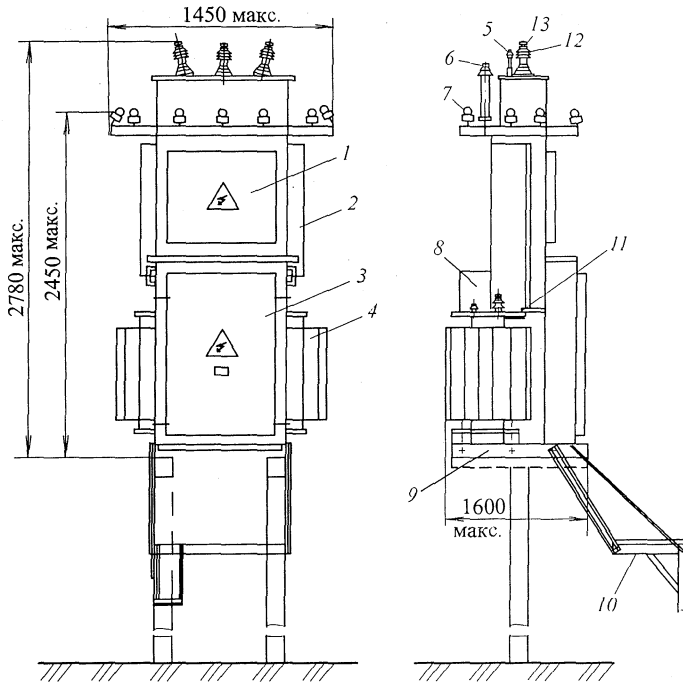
Габаритные и установочные размеры КТП-25—250/10/0,4-У1 шкафного типа:
